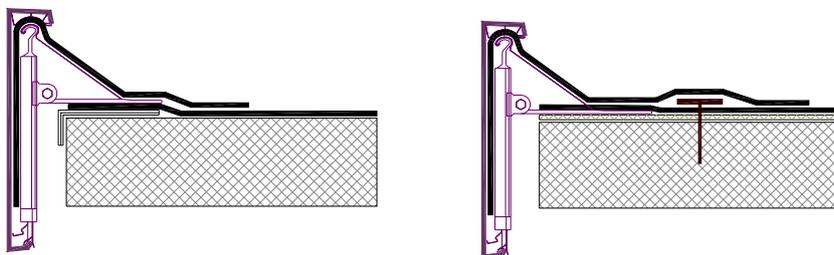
Dachrandabschluss mit mehrteiligen Metall-Klemmprofilen, rechte Darstellung bei vorhandenen mehrteiligen Metallprofilen
